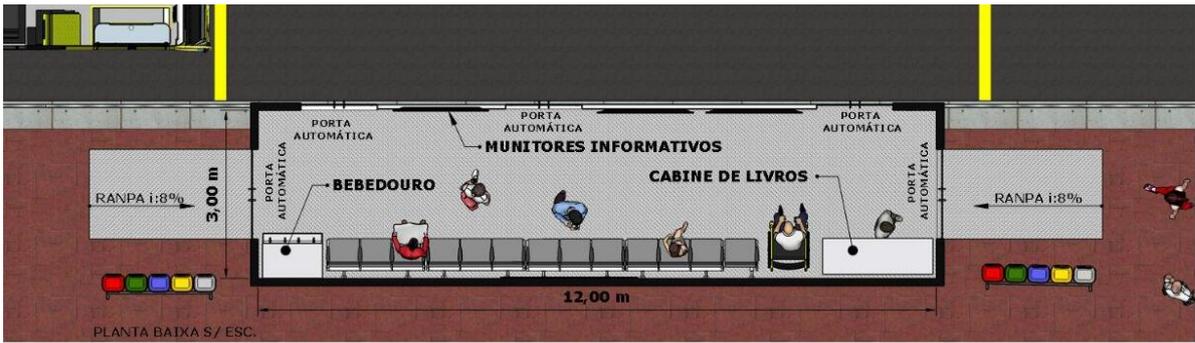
Planta baixa humanizada com detalhes internos e externos do projeto de intervenção (Acervo pessoal)
